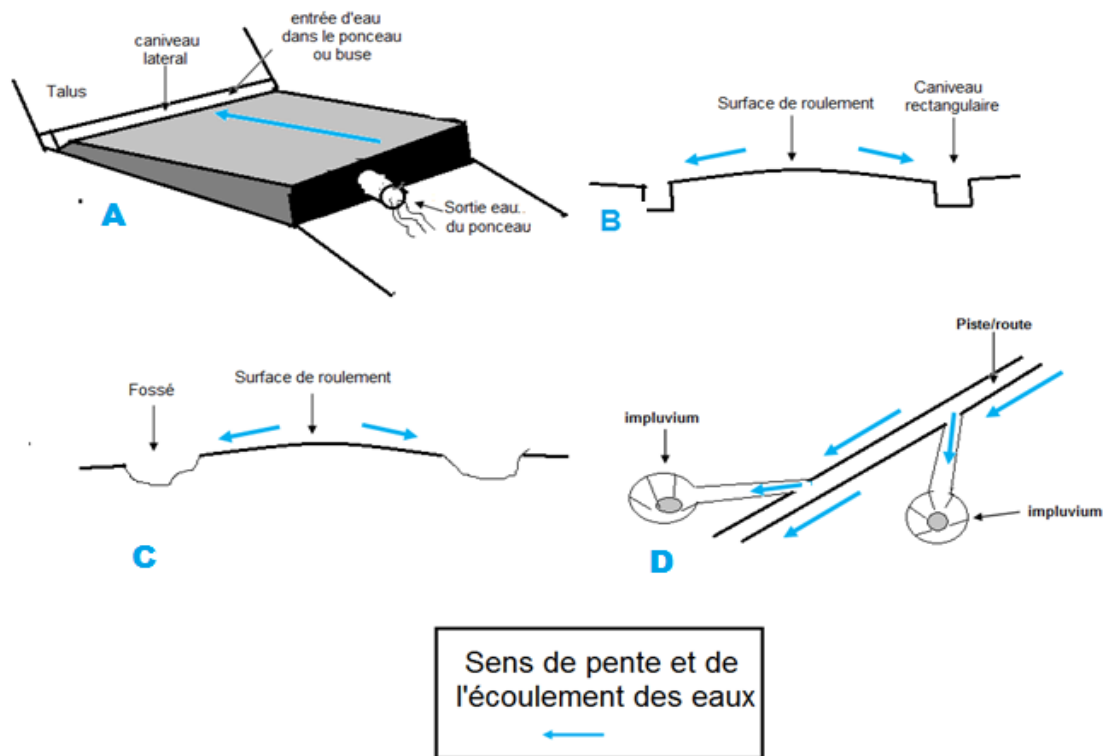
(A) Piste avec caniveaux latéraux rectangulaire, (B): Piste avec ponceau ou buse, en situation de terrasse, (C): Piste avec fossés latéraux, (D): Piste avec impluviums
